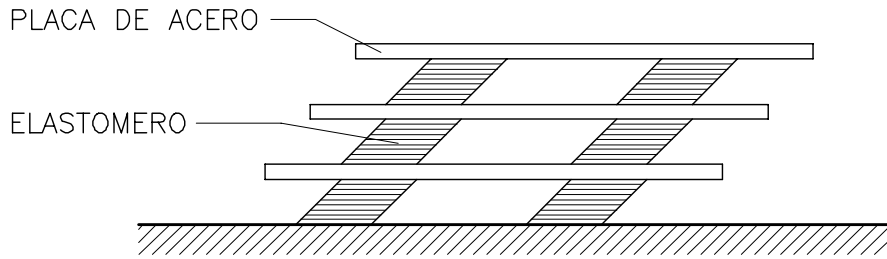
Dispositivo de apoyo de alta estabilidad.
